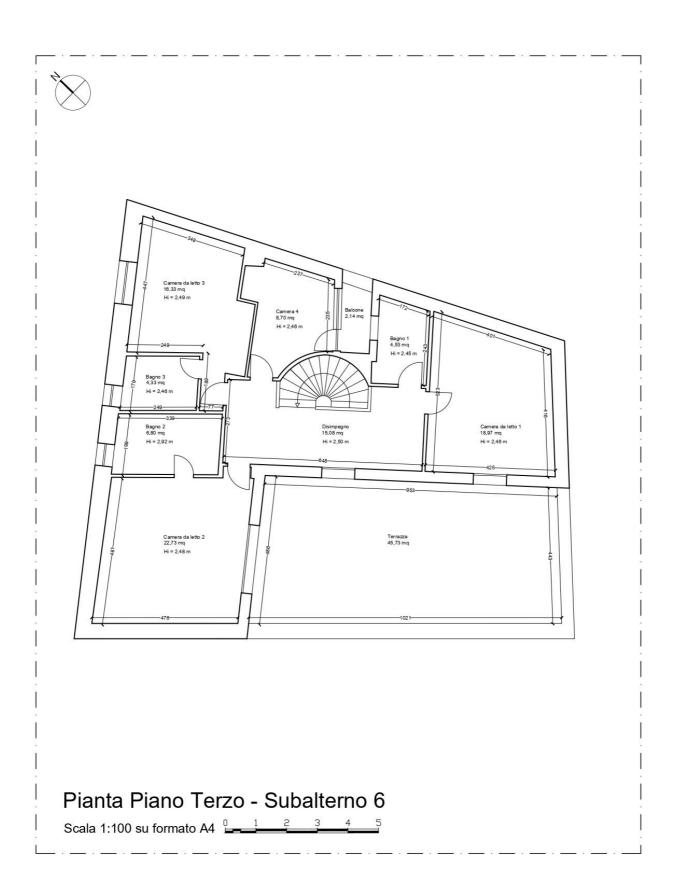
Piano Terzo/sottotetto – Subalterno 6 Planimetria dello stato di fatto rilevato
